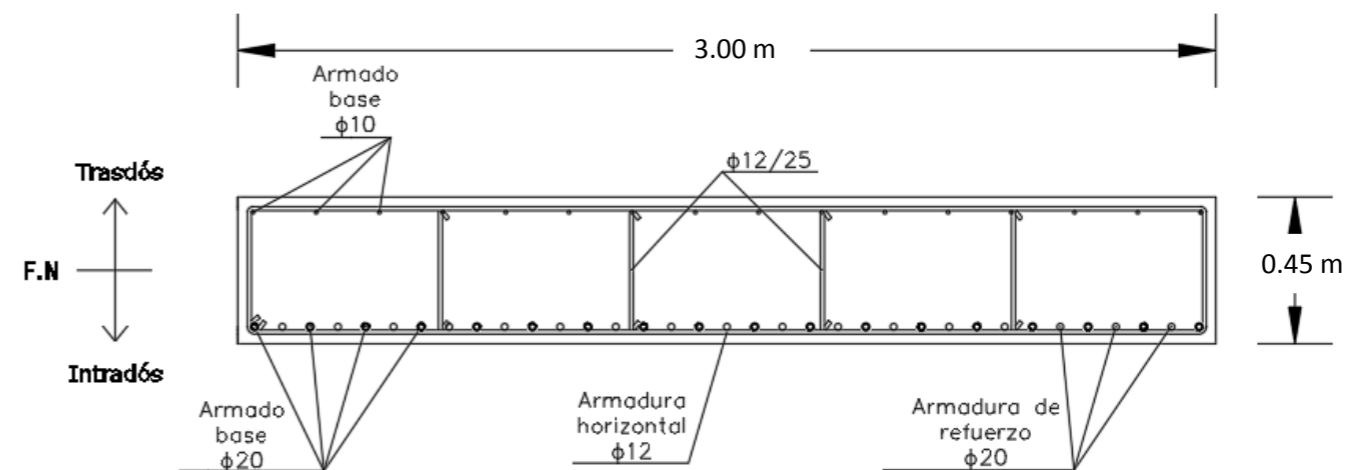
Disposición de la armadura del muro pantalla. Fuente: Elaboración propia.
